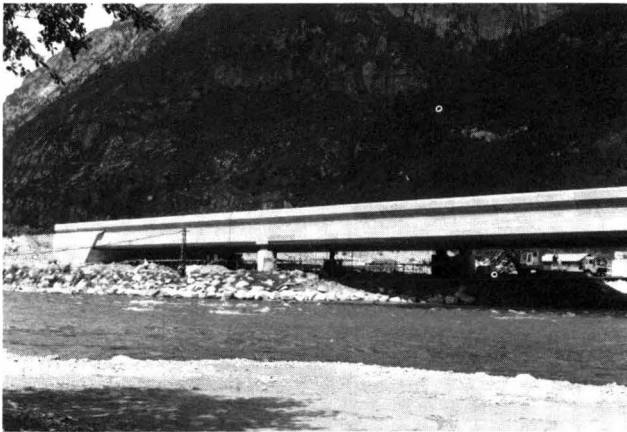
Sicht auf Längsträger – Vue du longeron du pont – View of box girder – Vista trave longitudinale
